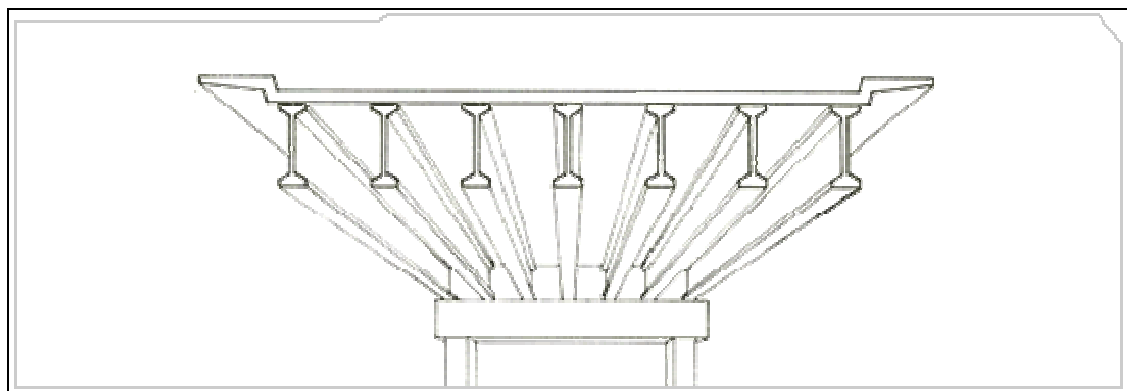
Sección transversal más común de los puentes que serán construidos
